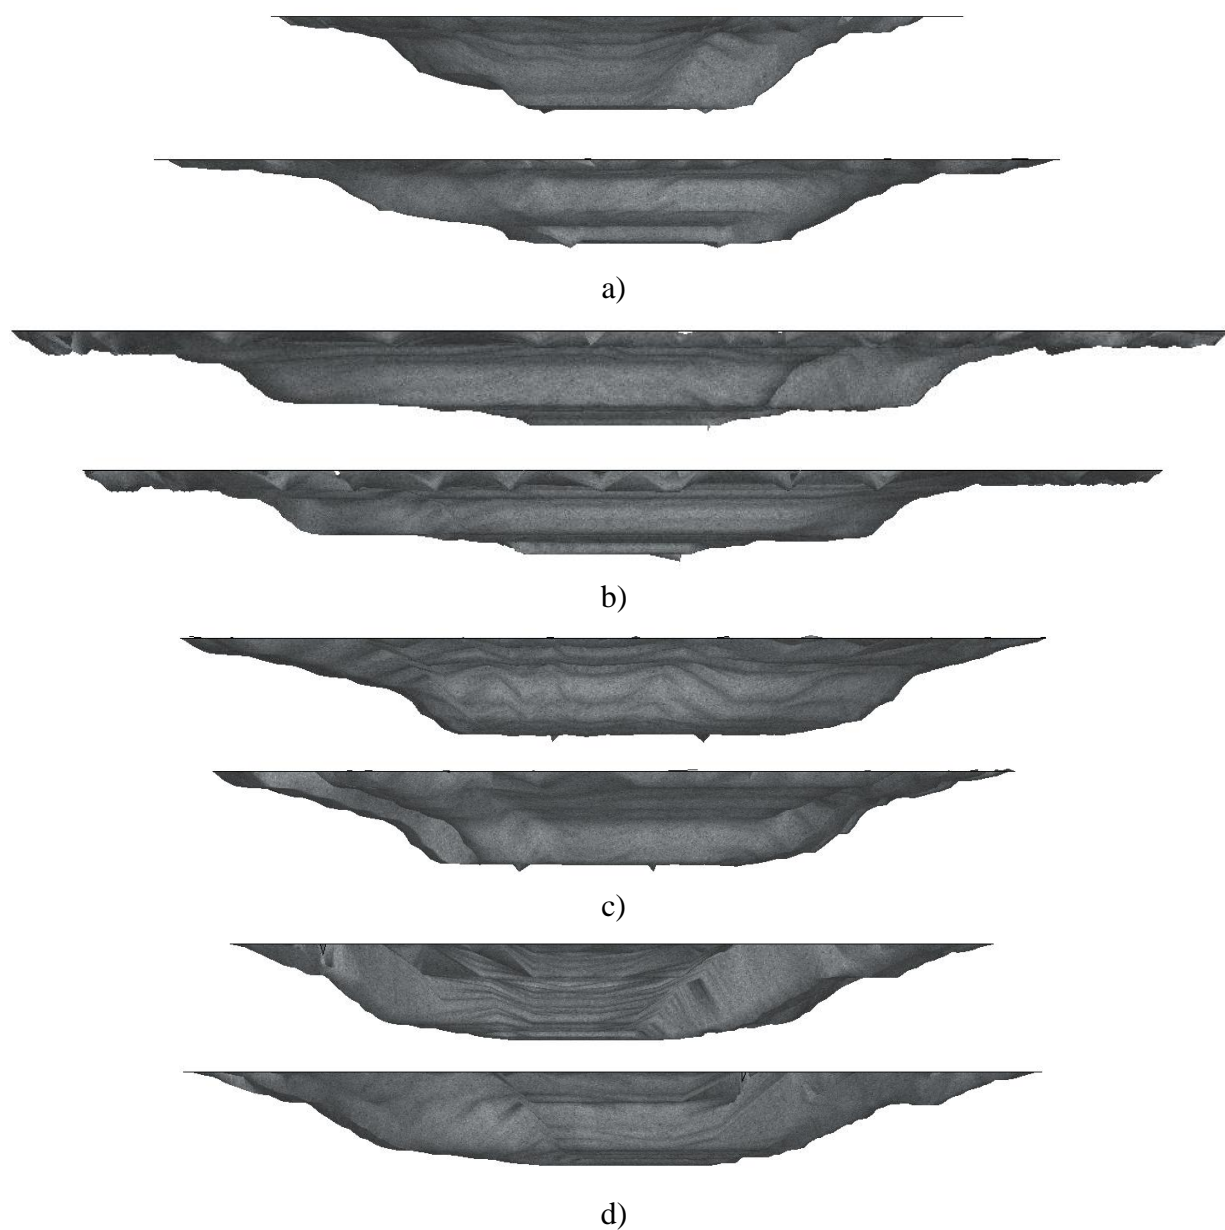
Vistas a 90 graus dos cones de punção; a) Laje RSP de referência; b) Laje FS-1; c) laje FS-2; d) Laje FS-3.
